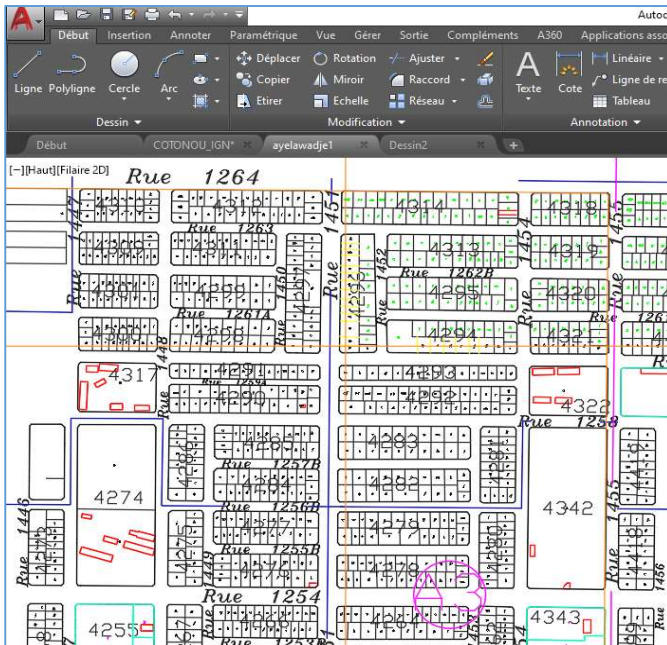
Plan AutoCad de Voirie et parcellaire extrait du lotissement d'Ayélawadjè
